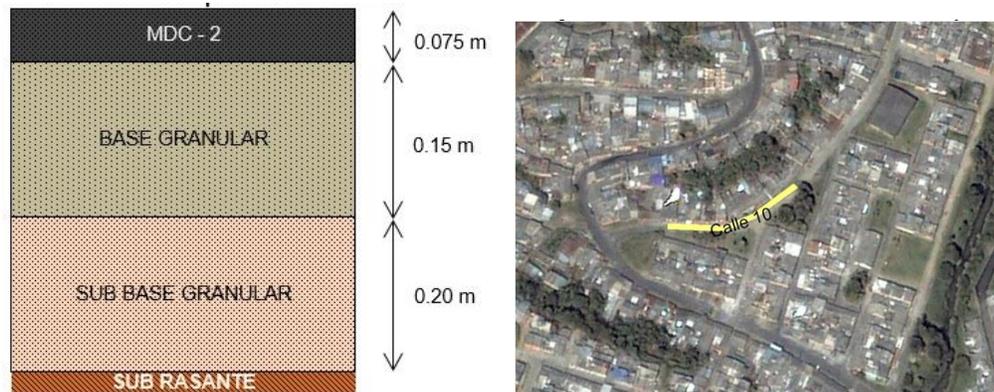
Movimiento de tierras. Estructura de pavimento Barrio Retiro Bajo.
